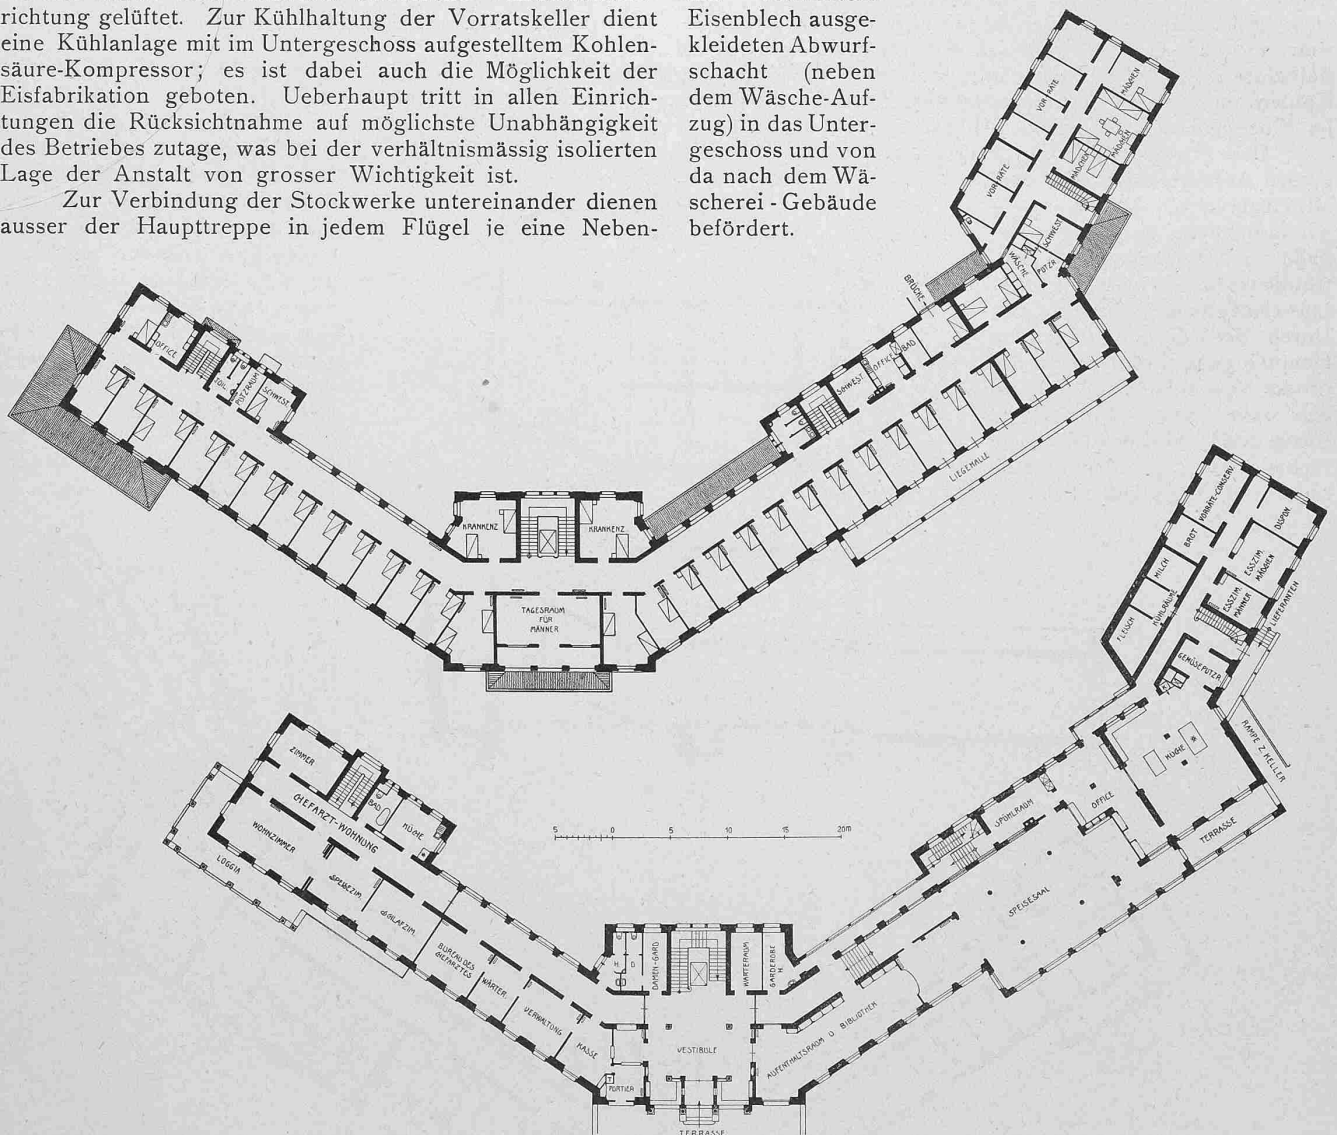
und 8. Grundrisse vom Erdgeschoss und I. Stock (Herren-Abteilung). — Masstab 1 : 600.
